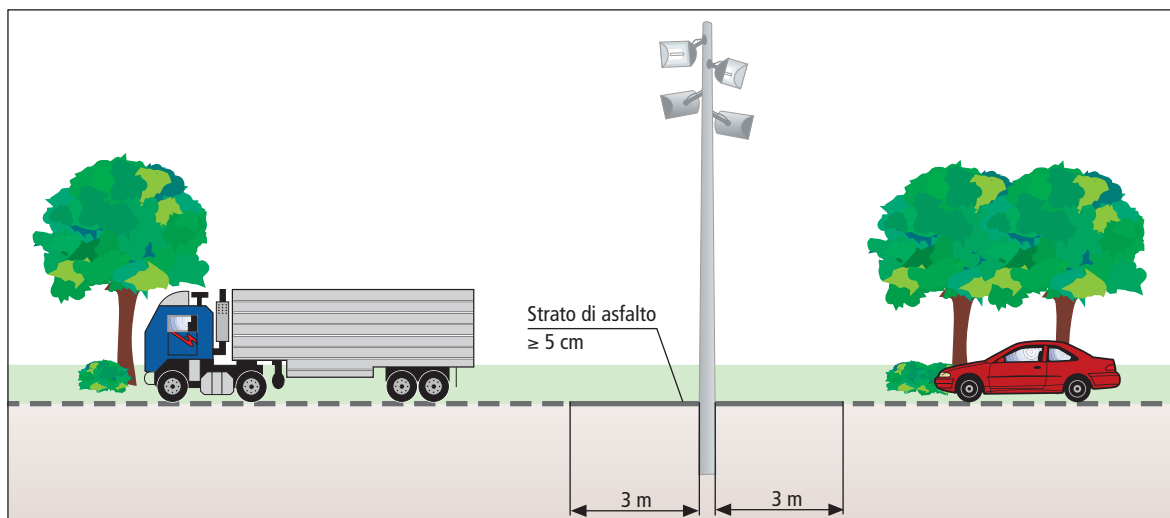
Isolamento del suolo per la riduzione delle tensioni di contatto derivanti da fulminazioni su un palo di illuminazione
